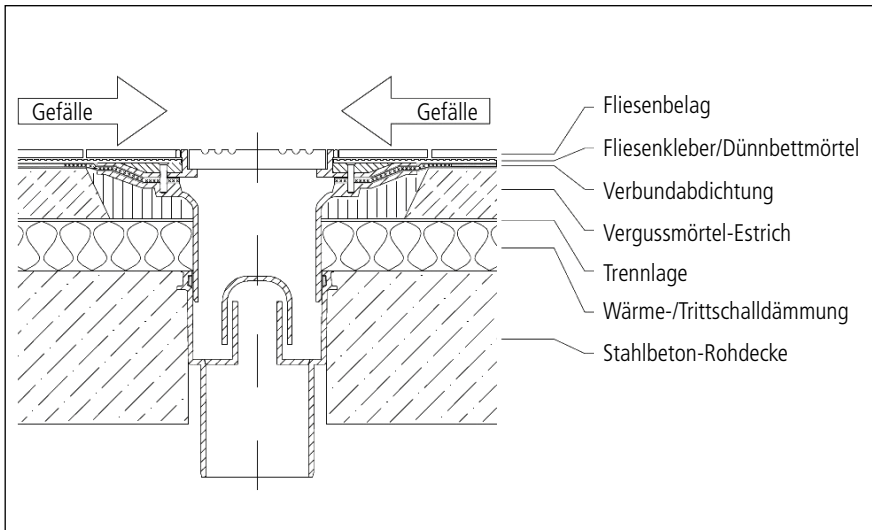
■ Anschluss eines Ablaufs an eine Verbundabdichtung mit Klemmflansch – Überblick [26]
